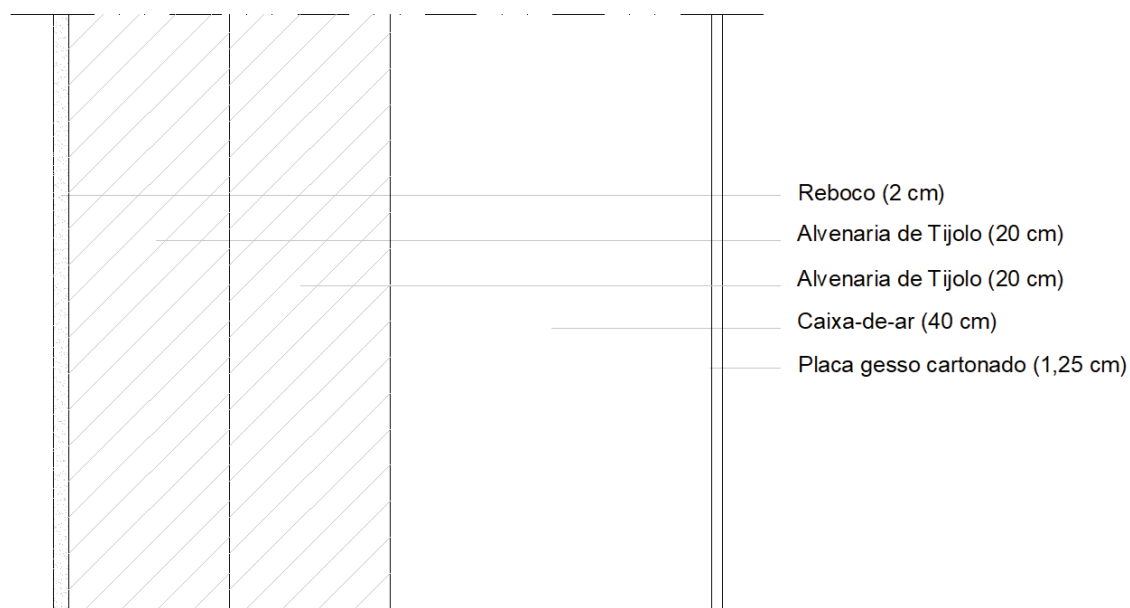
Pormenor construtivo da parede interior tipo XXI (Circulação)
